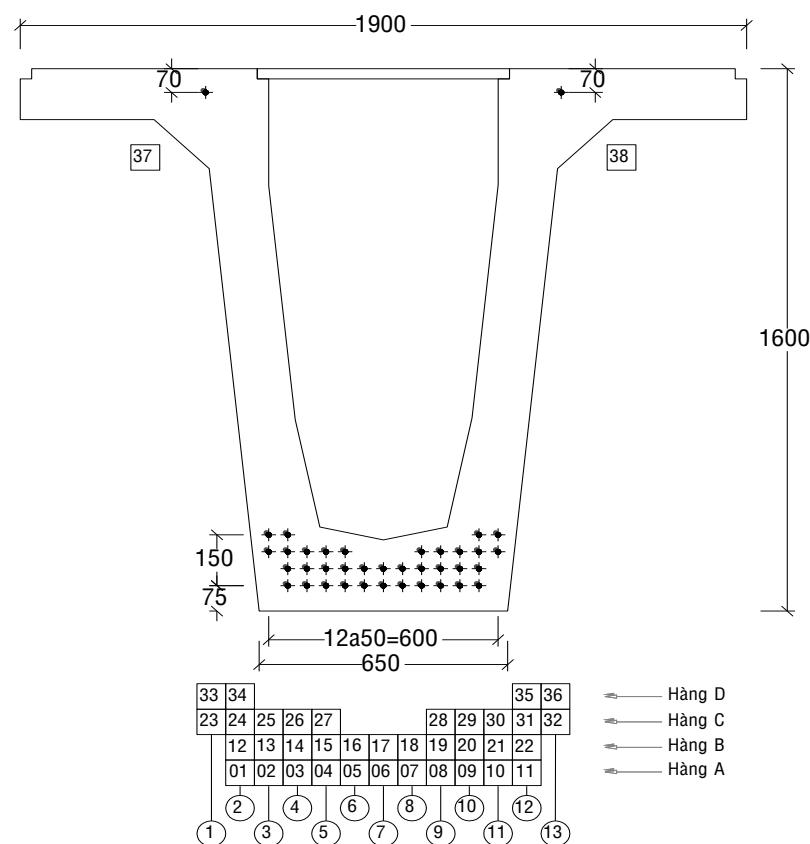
Bố trí cốt thép trong đoạn dầm đặc
